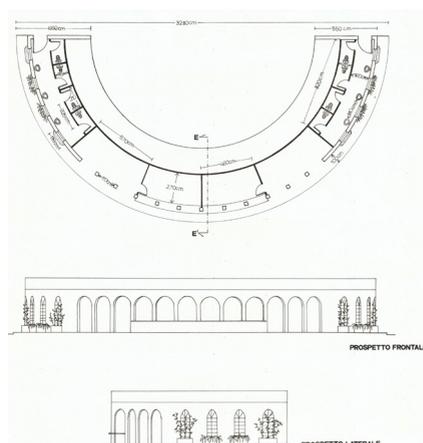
Ipotesi progettuale: Planimetria del settore centrale dei giardini con inserimento del teatro - scala 1:200.
